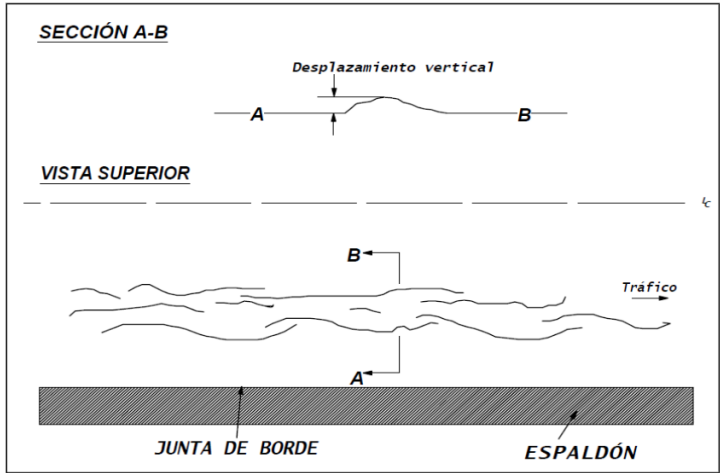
Esquema Hinchamiento- Pavimento Flexible
